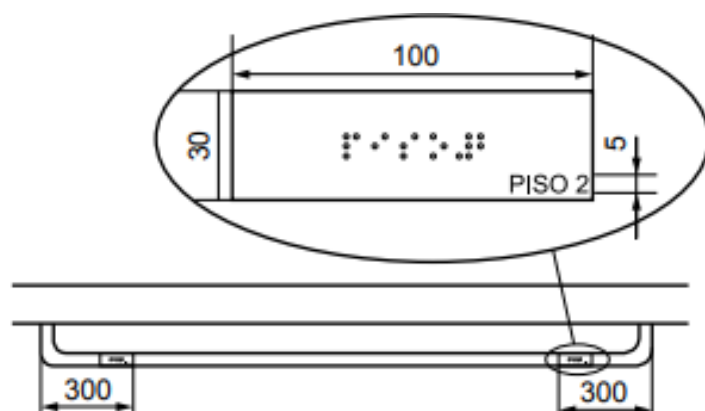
Sinalização de pavimento de corrimão em vista superior, dimensões em milímetros.
